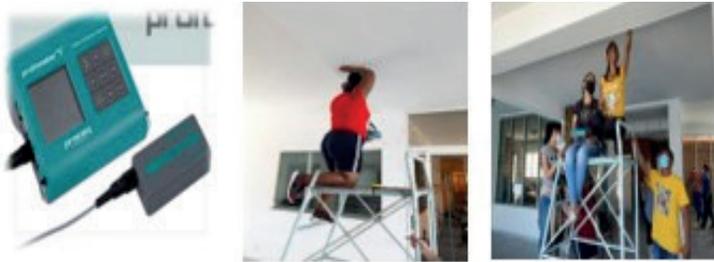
Equipo detector de aceros marca PROFO-METER y ensayo de detección de barras de acero en columnas y vigas. Fuente: Fotos tomadas por los autores.
